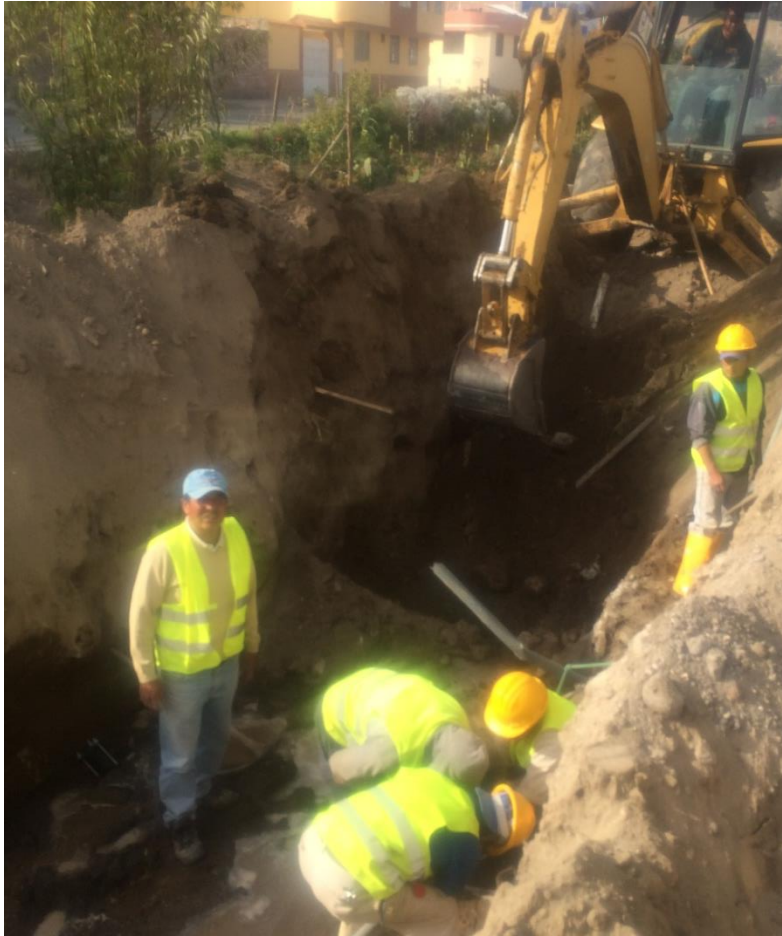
4: Replanteo y nivelación para Alcantarillado
